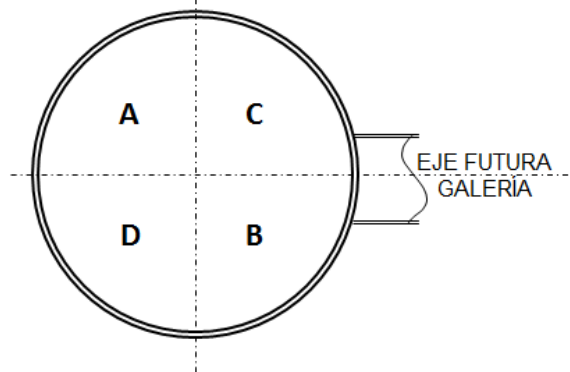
División de área de excavación de piques circulares de Metro de Santiago. Metro (2012a).
